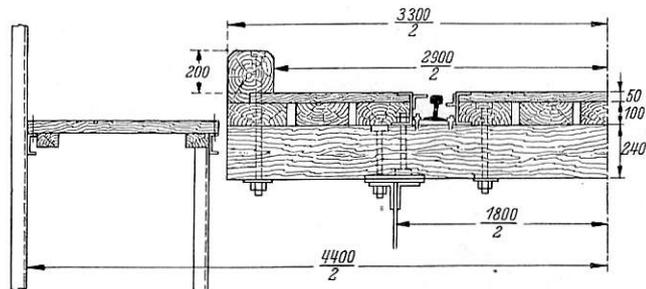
Fahrbahnquerschnitt der Donaubrücke bei Baja.
